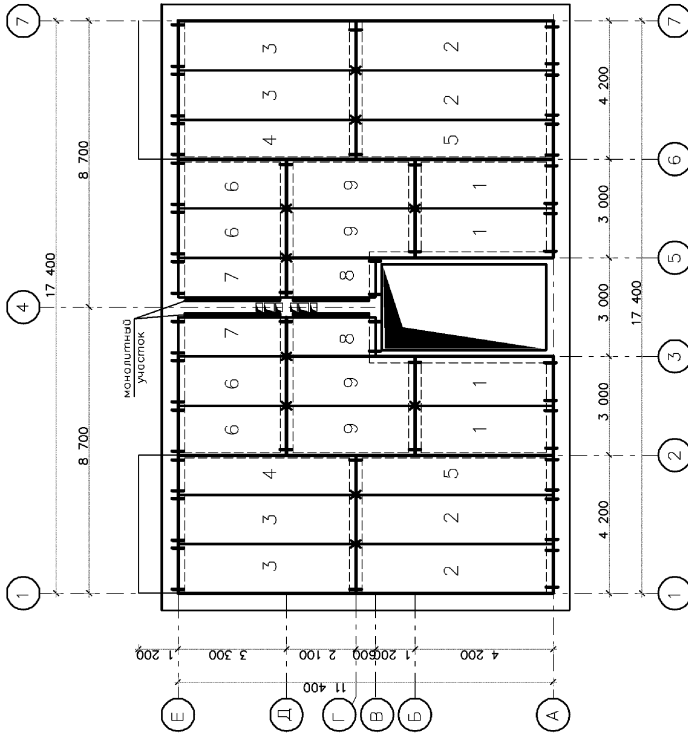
Пример оформления плана перекрытий из многоступенчатых плит настилов в зданиях со стенами из кирпича или мелких стеновых камней
